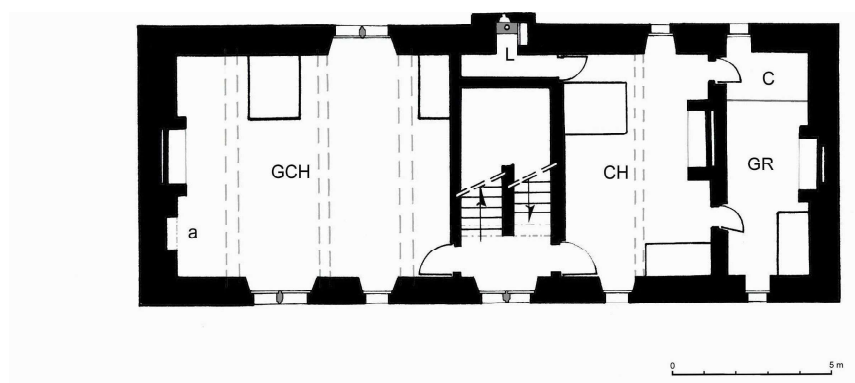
Longuelune. Plan restitué du premier étage entre 1546 et 1550.
